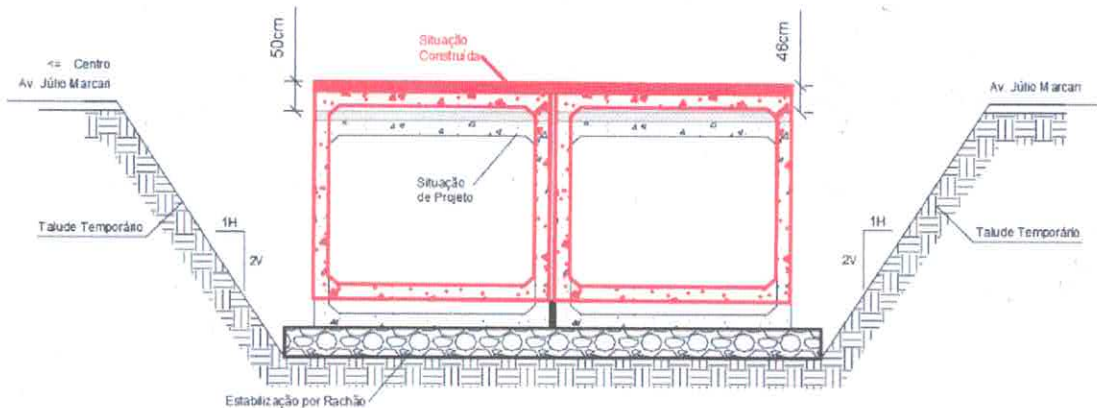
Situação Construída da Ponte Pres. Kennedy (em vermelho) e especificação de projeto
